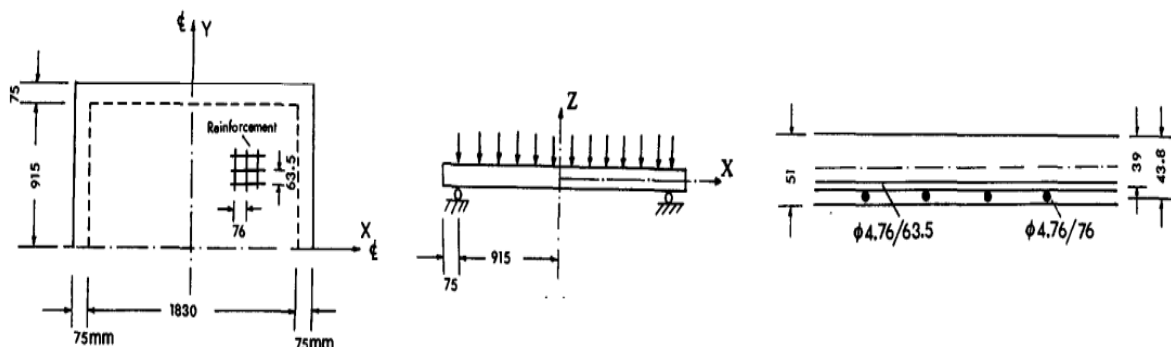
Dimensões e armaduras da laje do Exemplo 1
